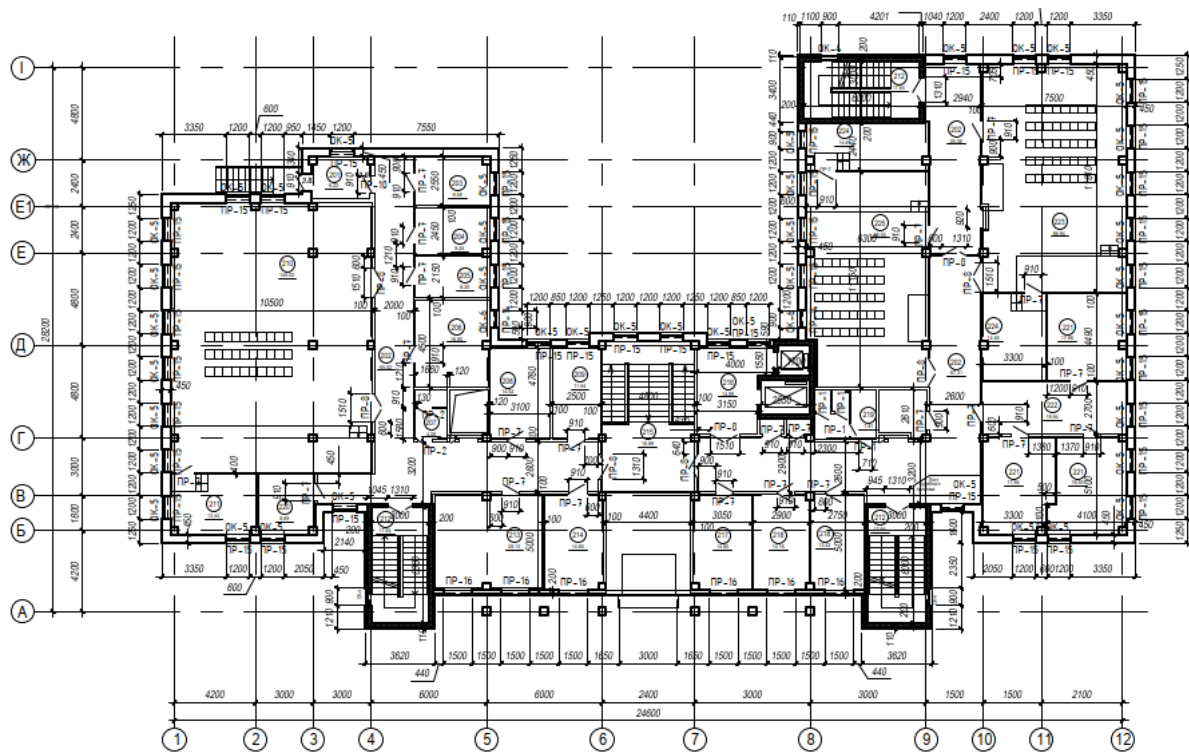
План будівлі на відмітці +3,300 (типовий поверх)
